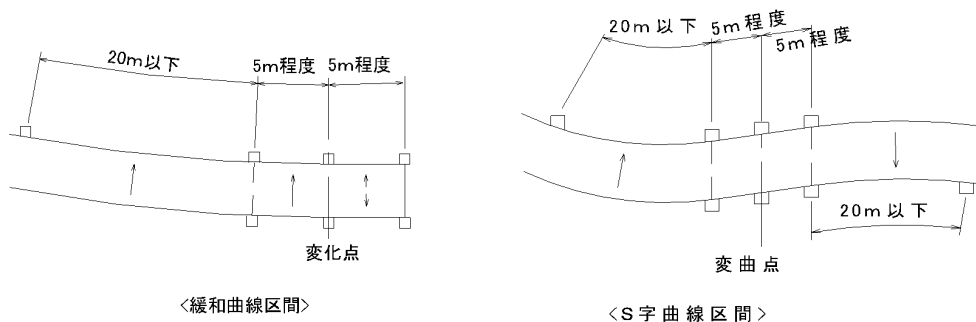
変曲点付近の排水樹の設置方法（平面図）
